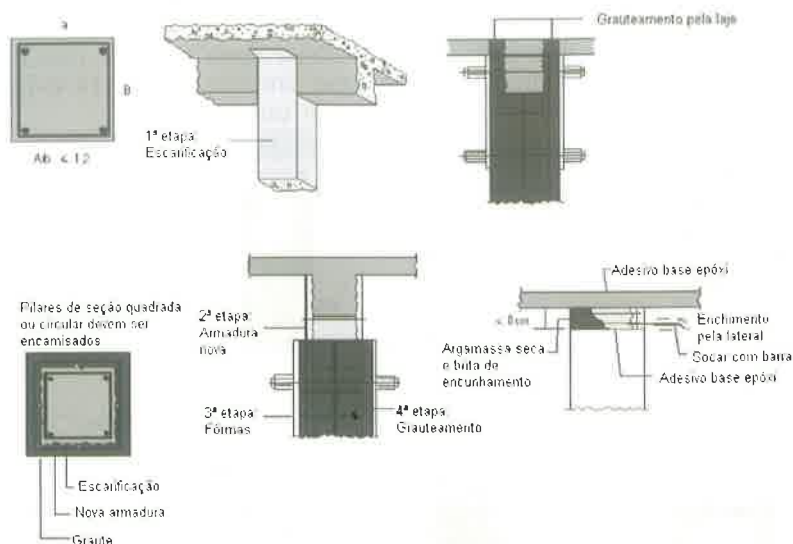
Reforço de pilares com argamassa fluida base epóxi.
